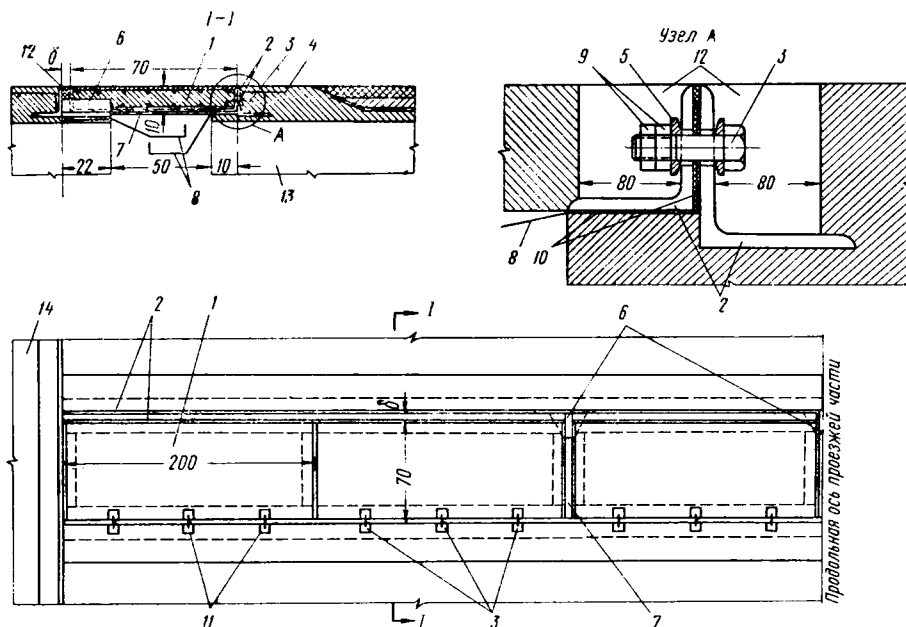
Схема перекрытия деформационного шва железобетонными плитами:
